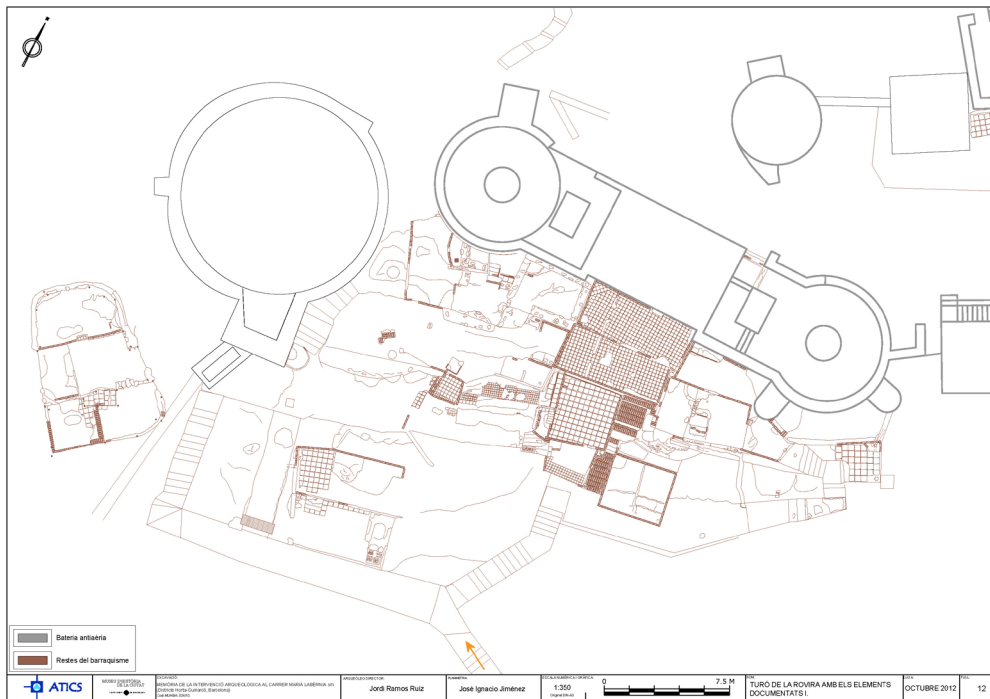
Planta detalle zona 1 de la excavación de la fase barraquista en el Turó de la Rovira.
